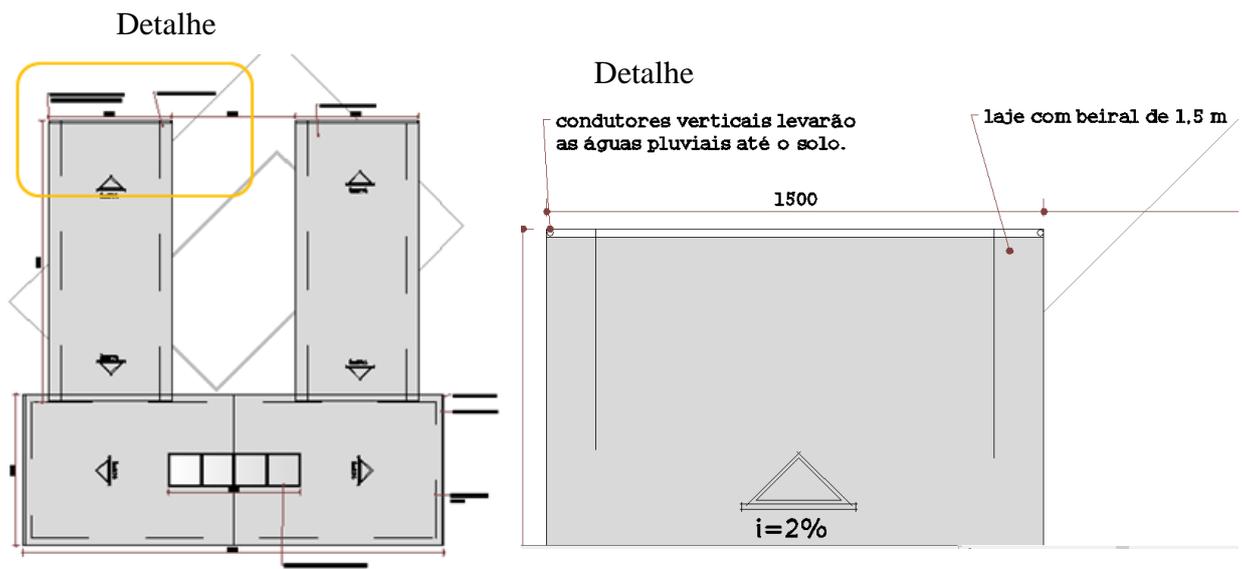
Planta de Cobertura mostrando a laje impermeabilizada, com detalhe nas calhas e condutores.
